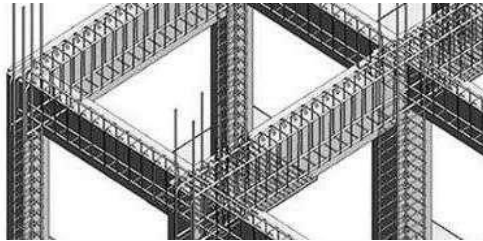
Konsep Struktur Bawah (Pondasi Footplate & pondasi menerus)
